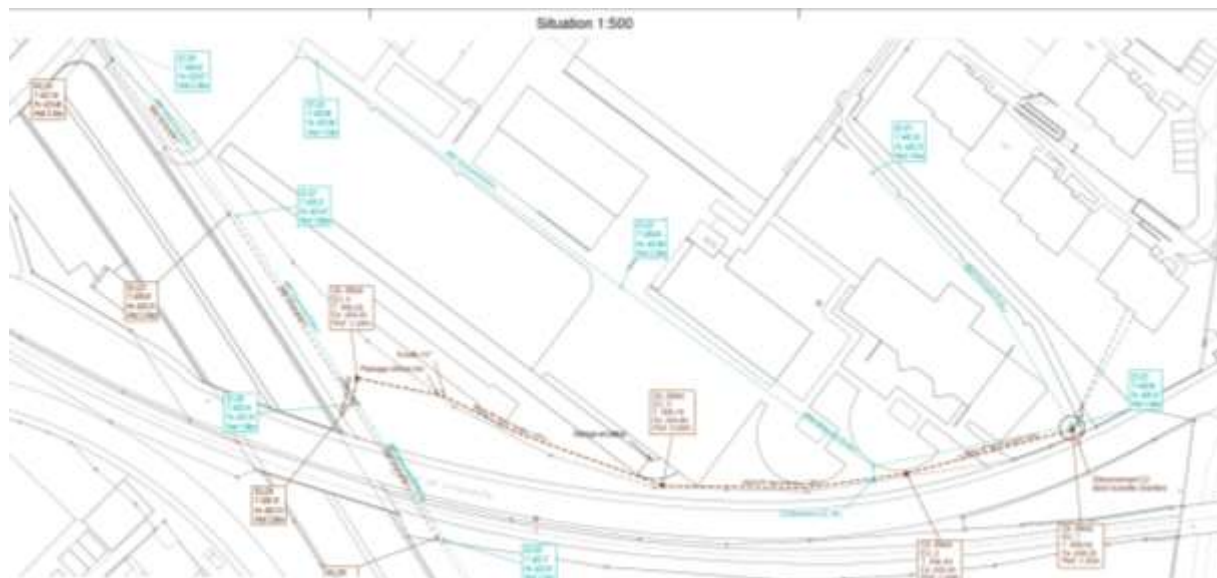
Plan du projet d'exécution. La nouvelle canalisation est représentée en brun sur le plan
